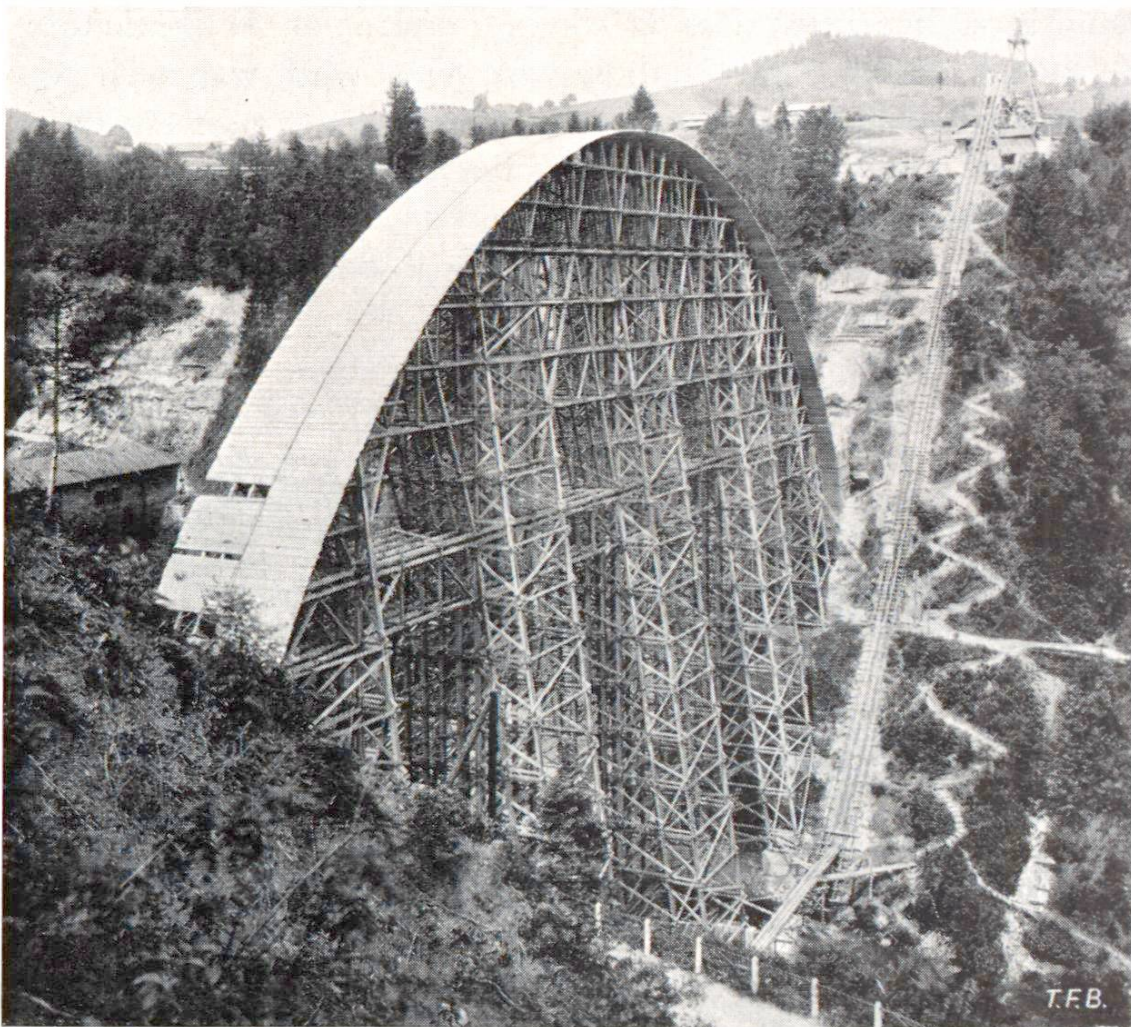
\* Bau der grossen Eisenbetonbrücke auf dem Hundwilertobel - Spannweite 105 m. Die Gesamtansicht des Lehrgerüsts und der Transportanlagen zeigt, welche gewaltige Holz-mengen beim Bau von Eisenbetonkonstruktionen verbraucht werden.
